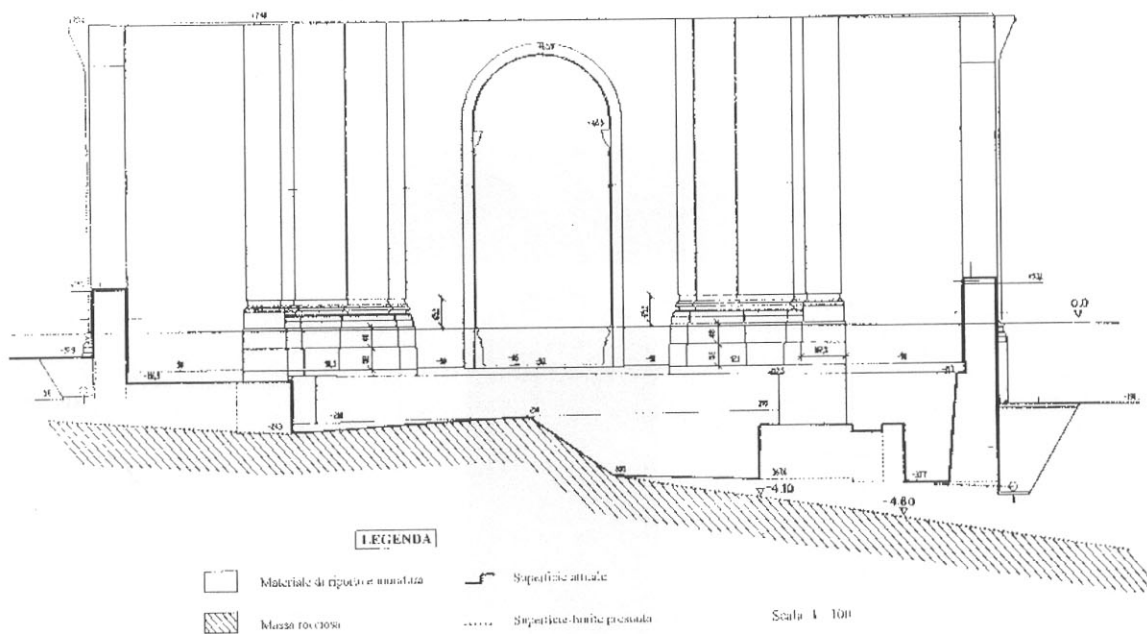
Sezione stratigrafica per il restauro della chiesa di San Pietro
